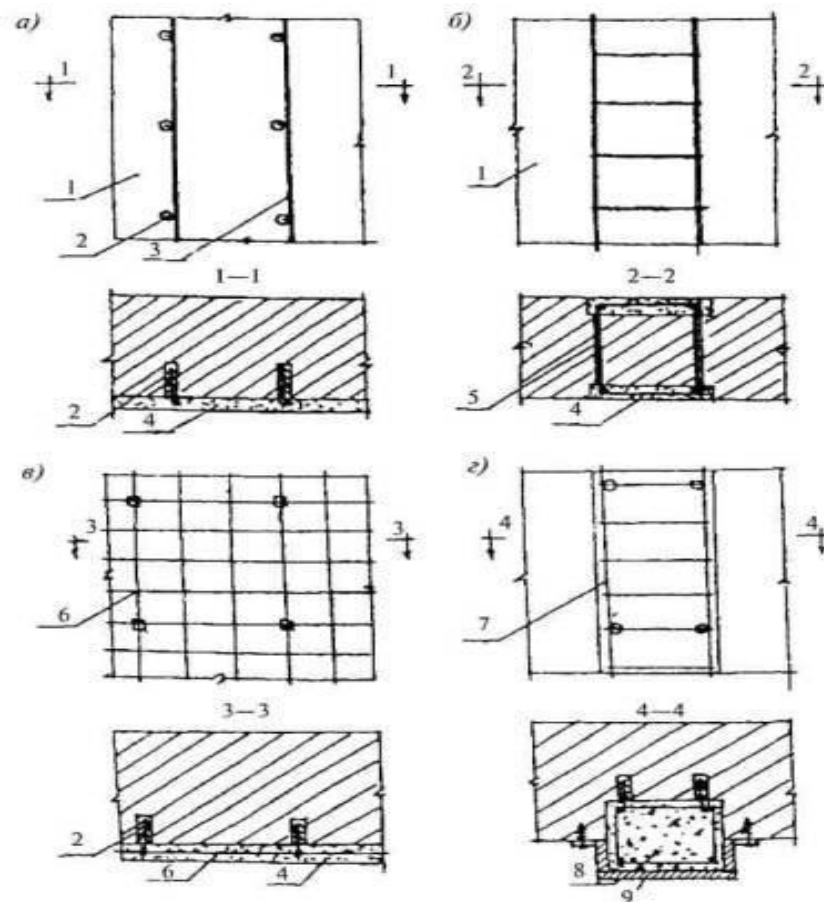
Посилення цегляних стін армуванням *а* - окремими стержнями арматури; *б* - арматурними каркасами; *в* - арматурною сіткою; *г* - залізобетонними пілястрами : 1 - посилювана стіна; 2 - анкери; 3 - арматура; 4 - штукатурний або торкрет-бетонний шар; 5 - металеві тяжи; 6 - арматурна сітка; 7 - армокаркас; 8 - бетон; 9 - опалубка
